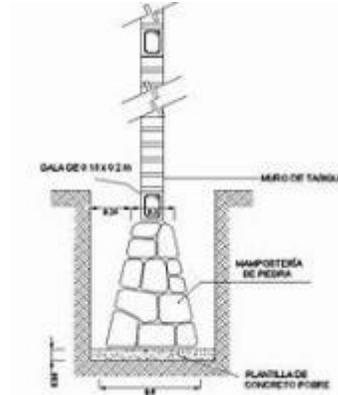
Estructura de la cimentación de estudio dormitorio.
